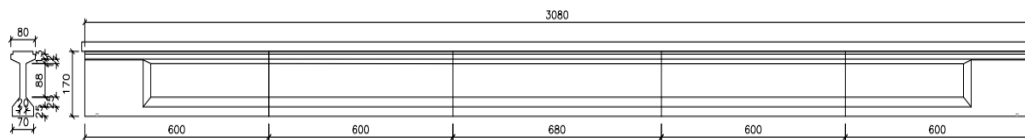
Desain ulang *Girder* 16 m dan Eksisting
